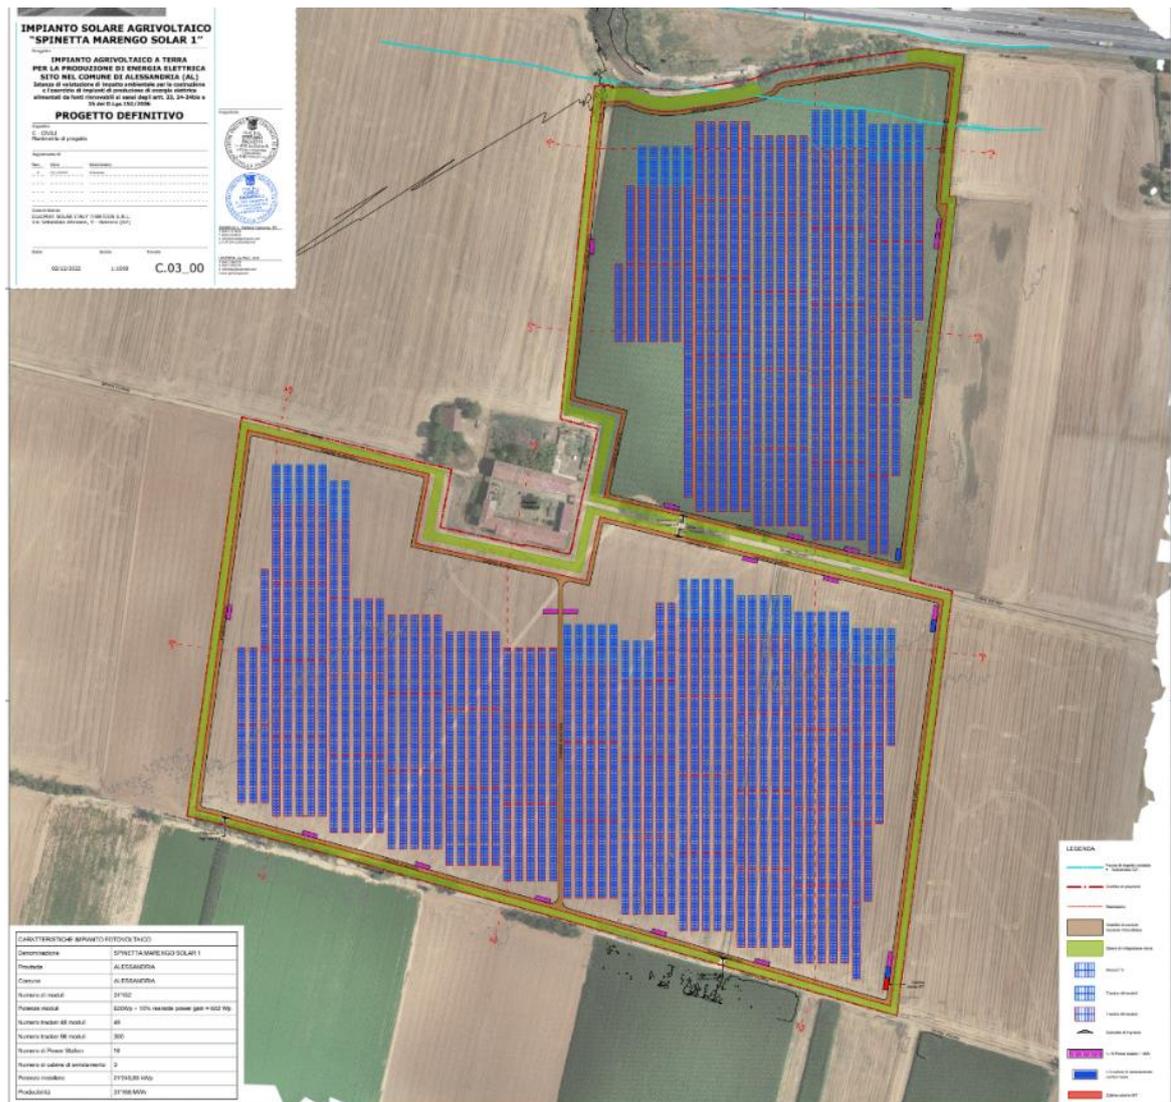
Planimetria di progetto. Tavola C_03_00 di progetto
